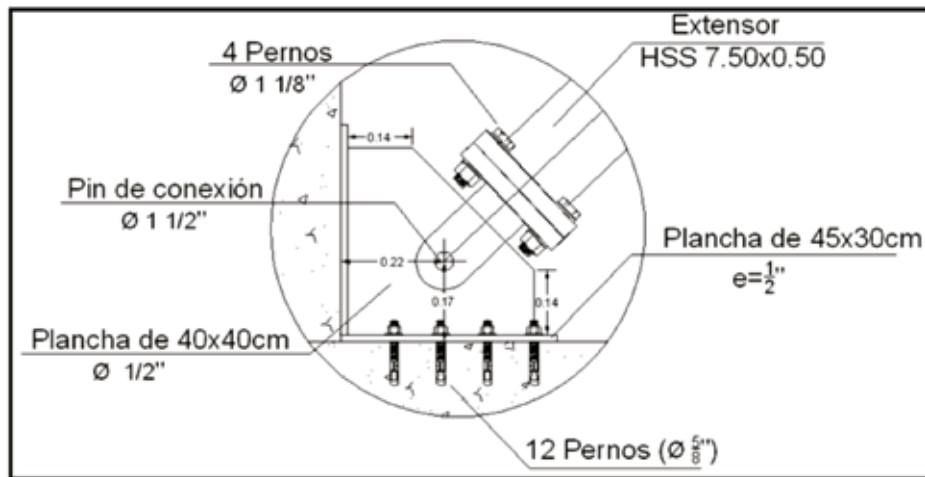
DETALLE 1 (CONEXIÓN BRAZO METÁLICO – CARTELA - ESTRUCTURA DE CONCRETO)
